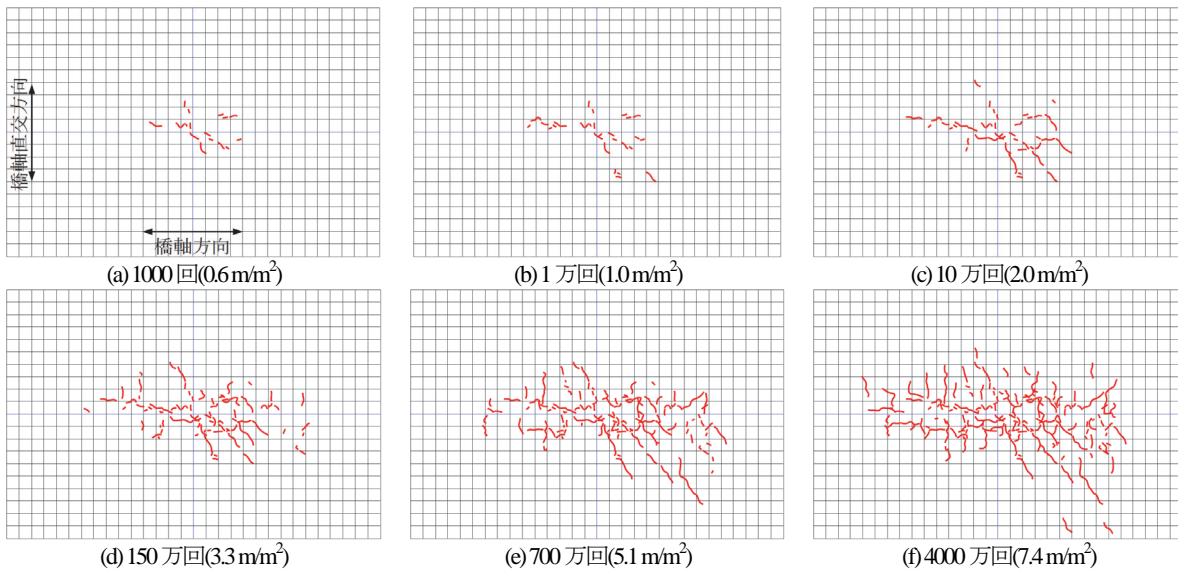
B供試体のひび割れ状況 ()内数値 ひび割れ密度m/m²
